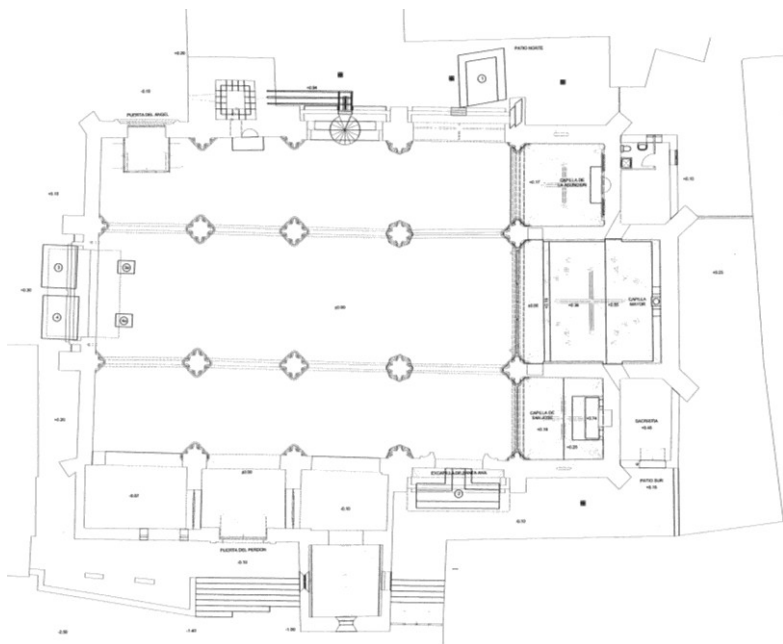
Plano de situación de las catas arqueológicas Antonio Molina Expósito Arqueólogo, sobre planimetría elaborada por el autor
